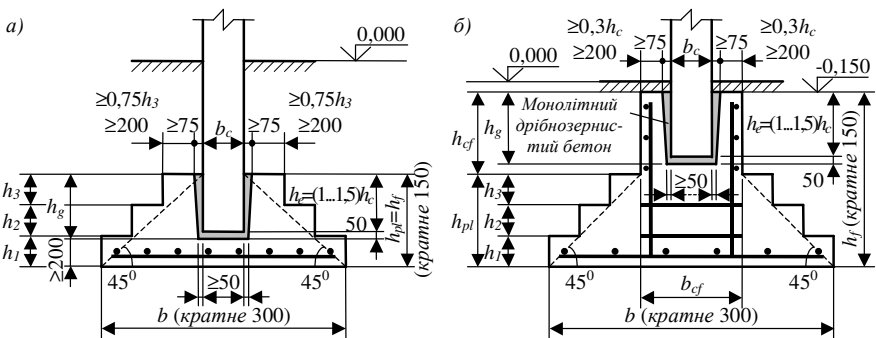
Ступчасті монолітні залізобетонні фундаменти стаканного типу під збірну залізобетонну колону: а - фундамент, що складаються лише з плитної частини; б - фундамент, що вміщає плитну частину і розвинений підколонник; b_c і h_c - розміри поперечного перерізу колони; h_{cf} і b_{cf} - відповідно висота та ширина підколонника; h_{pl} - висота плитної (конструктивної) частини; h_g - висота стаканної частини; h_e - величина замурування колони у фундамент
